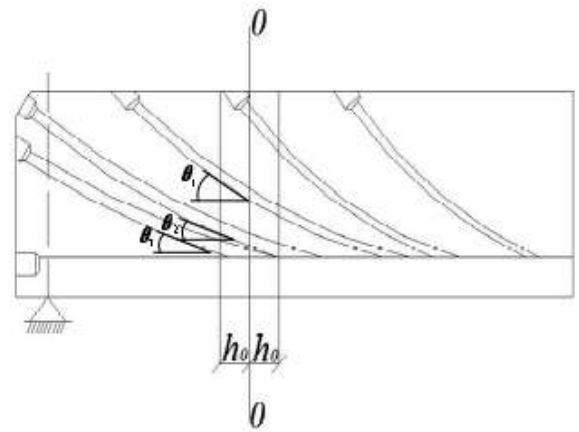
Схема розташування арматури, яка враховується при розрахунку перерізу 0-0 на головні розтягуючі напруження.
